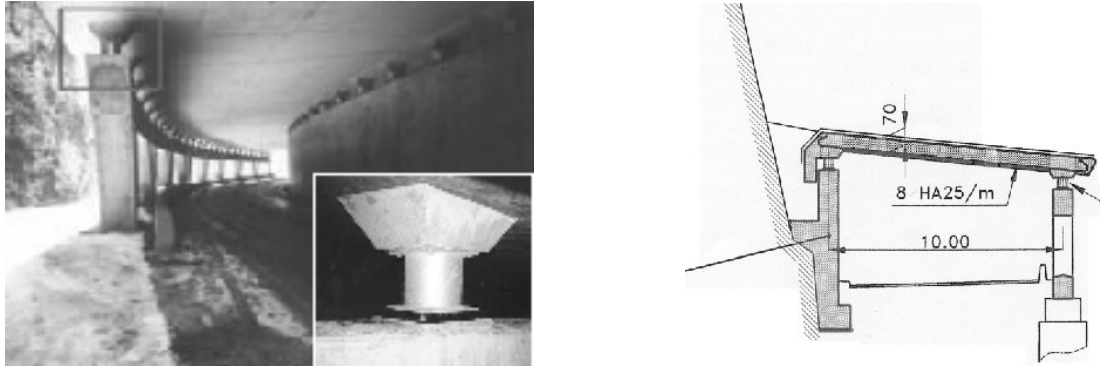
Galerie Pare-bloc Structurellement Dissipante – Les Essariaux - Savoie
